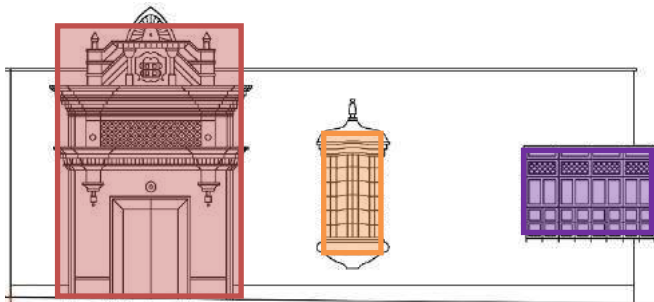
Elevación de la Casa del Mayorazgo de Facalá por el Jr. Pizarro
